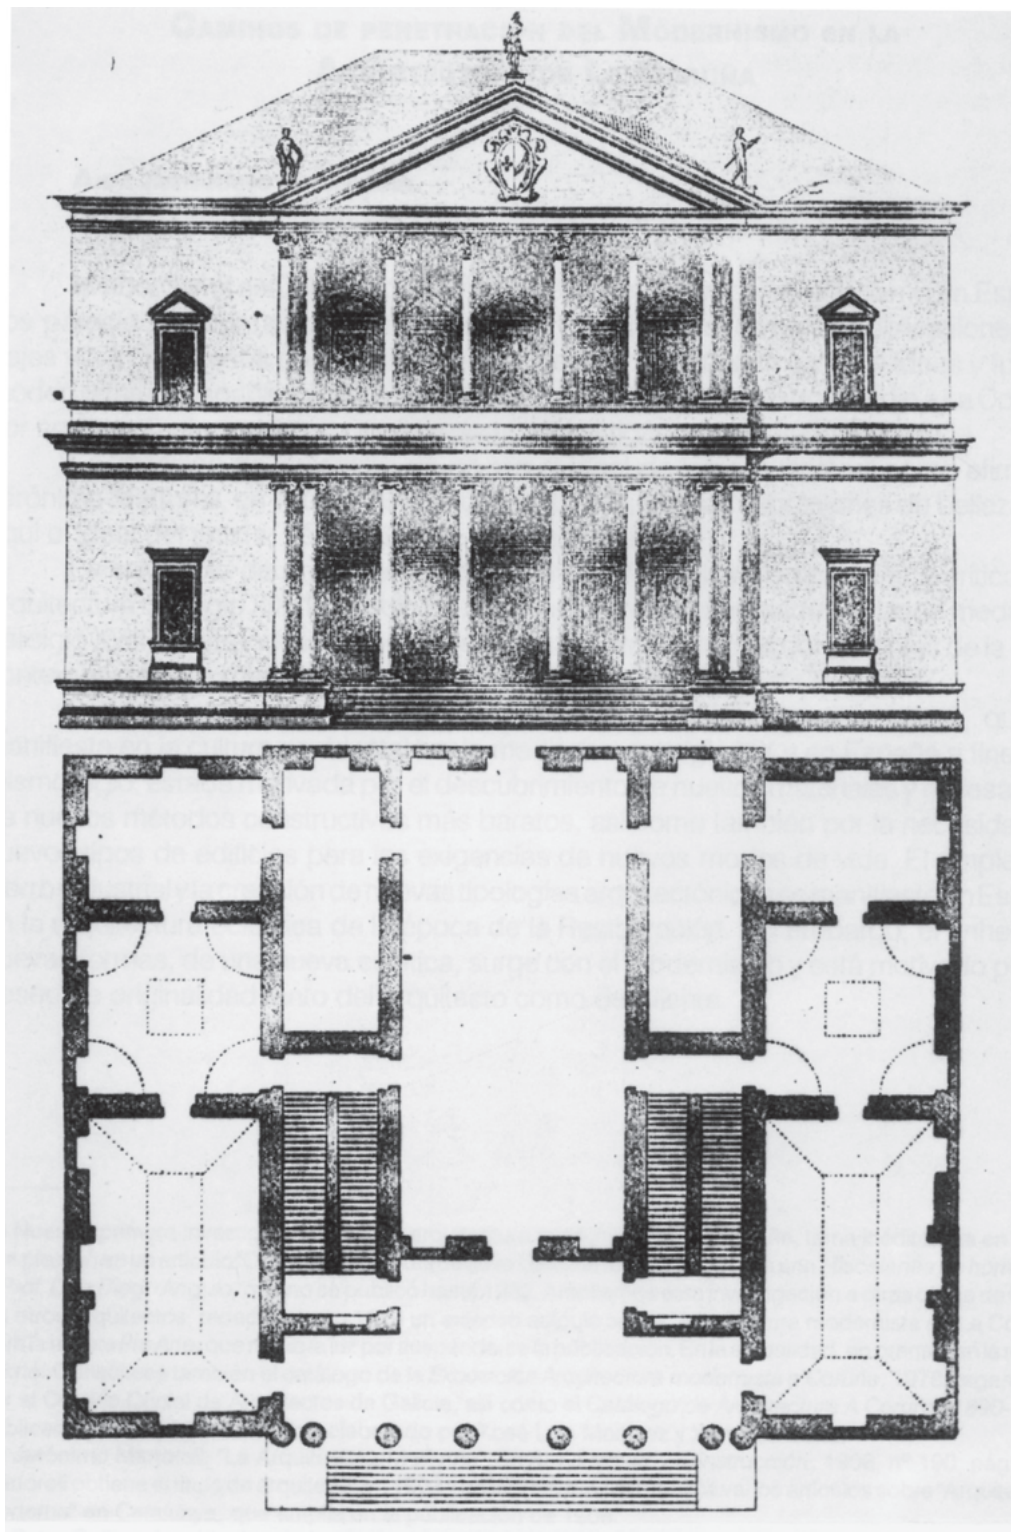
Palladio. Planta y fachada principal de la villa Sarego della Miega.
